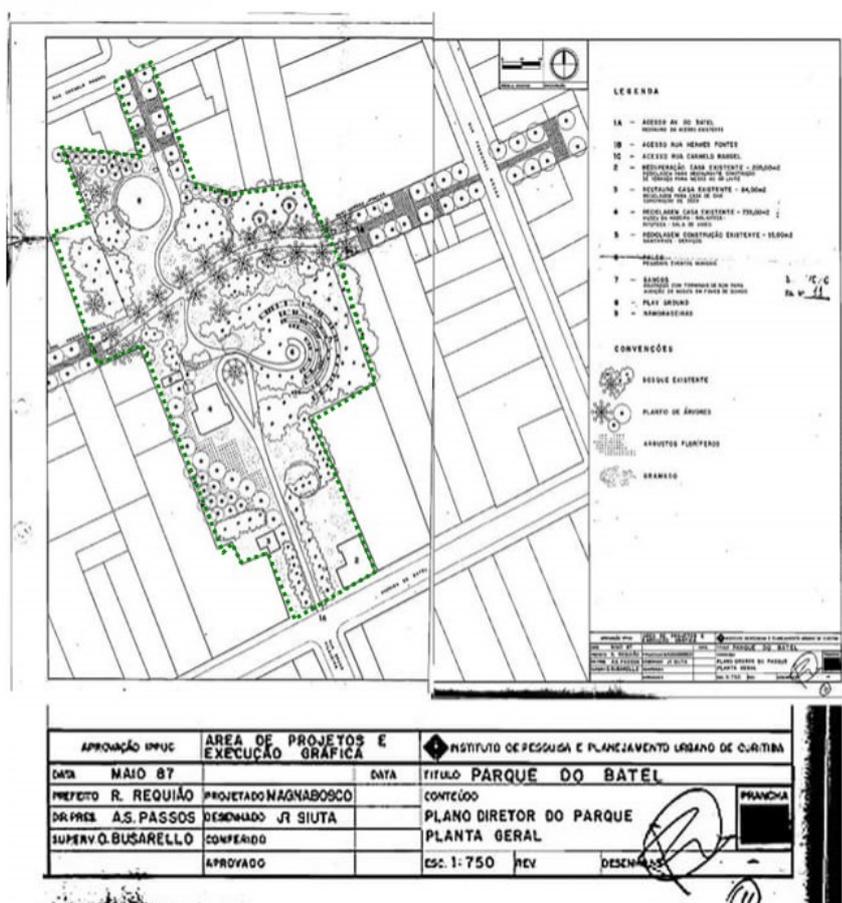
Planta do Parque do Batel – IPPUC (1987) Fonte: SBDCG, elaboração própria.
